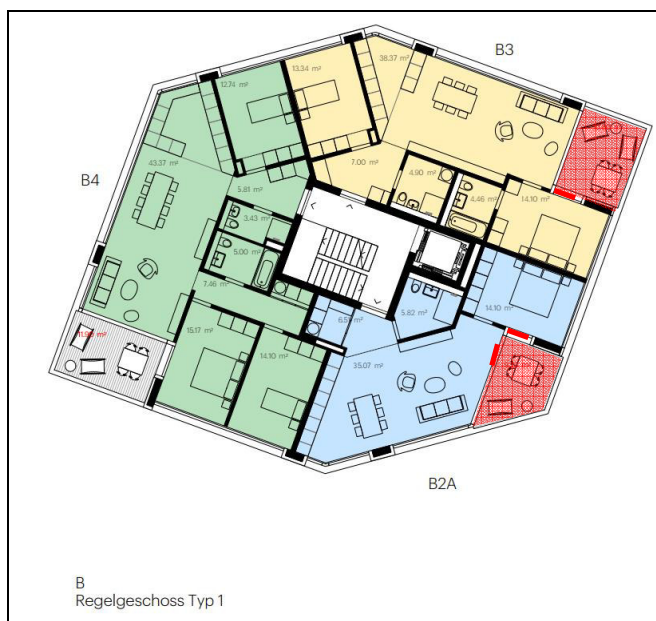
Haus B - Grundriss - Bereich Massnahmen aufgrund Strassenverkehrslärms
